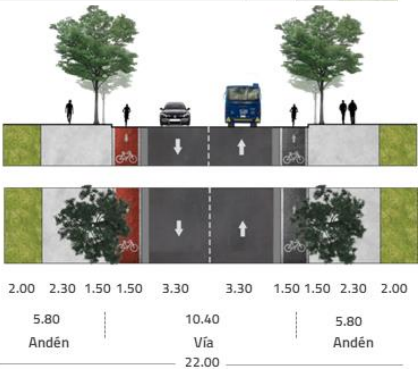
Perfil vial Avenida parque guaymaral sur
